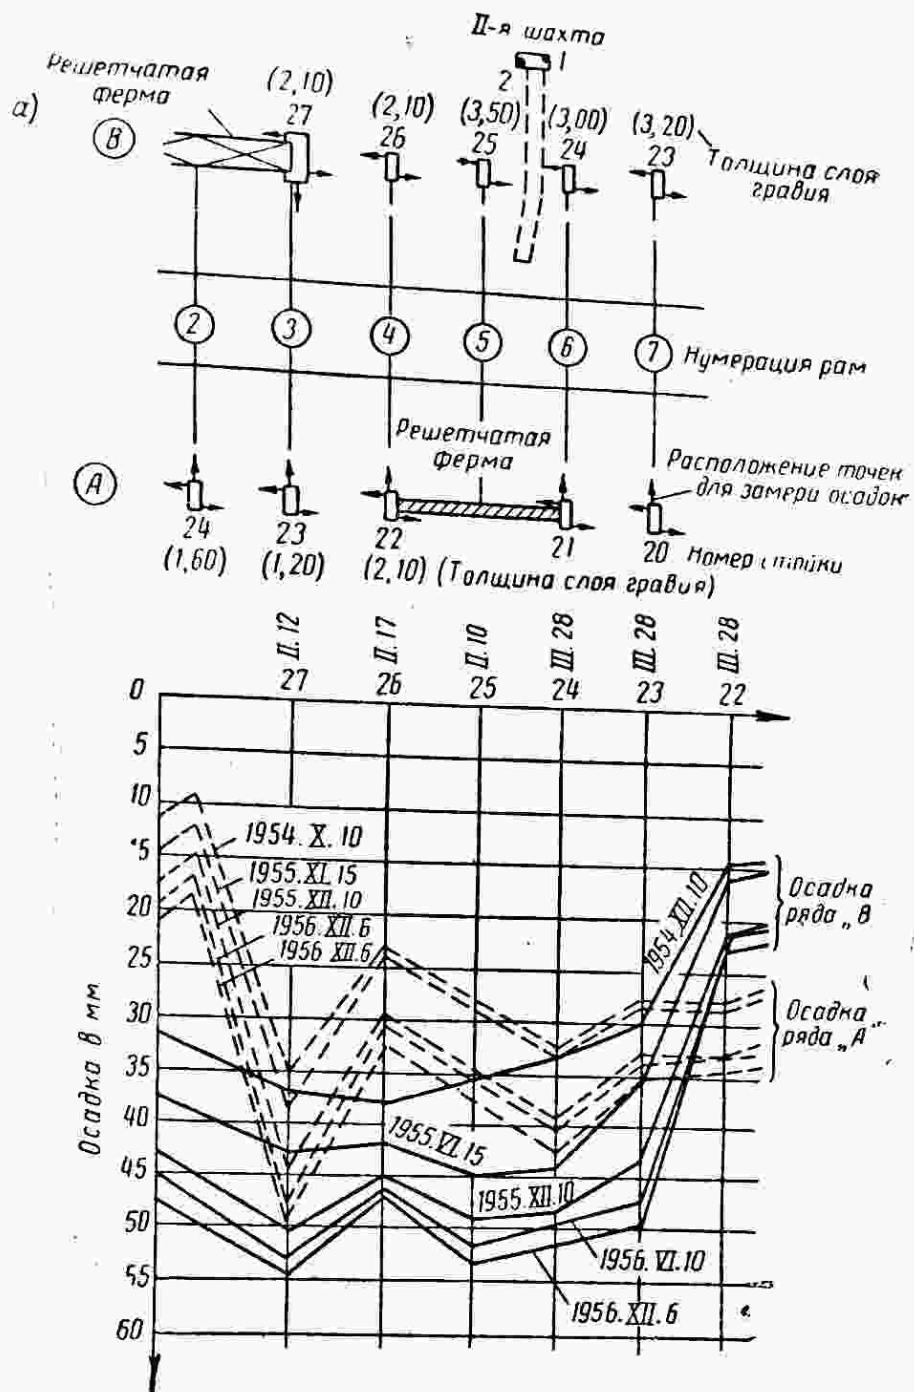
а. Осадка фундаментов стоек здания прокатного цеха и ее протекание во времени
